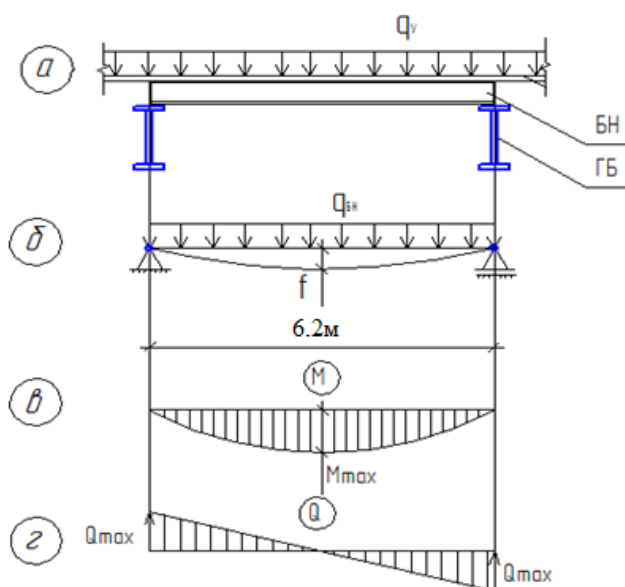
а) конструктивная схема; б) расчетная схема; в) эпюра изгибающих моментов; г) эпюра перерезывающих усилий.
